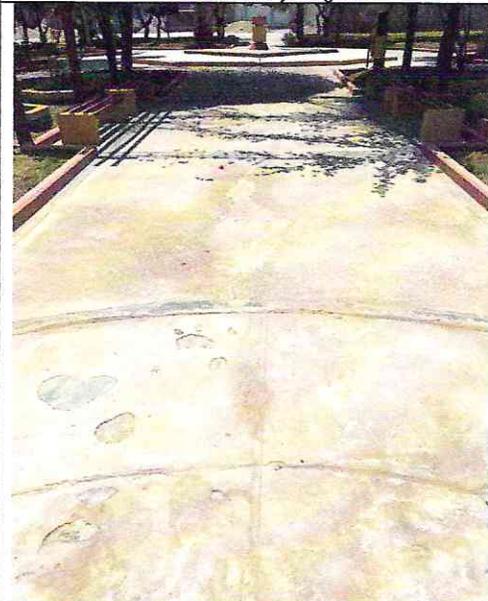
Veredas de concreto con fisuras y desgaste.
